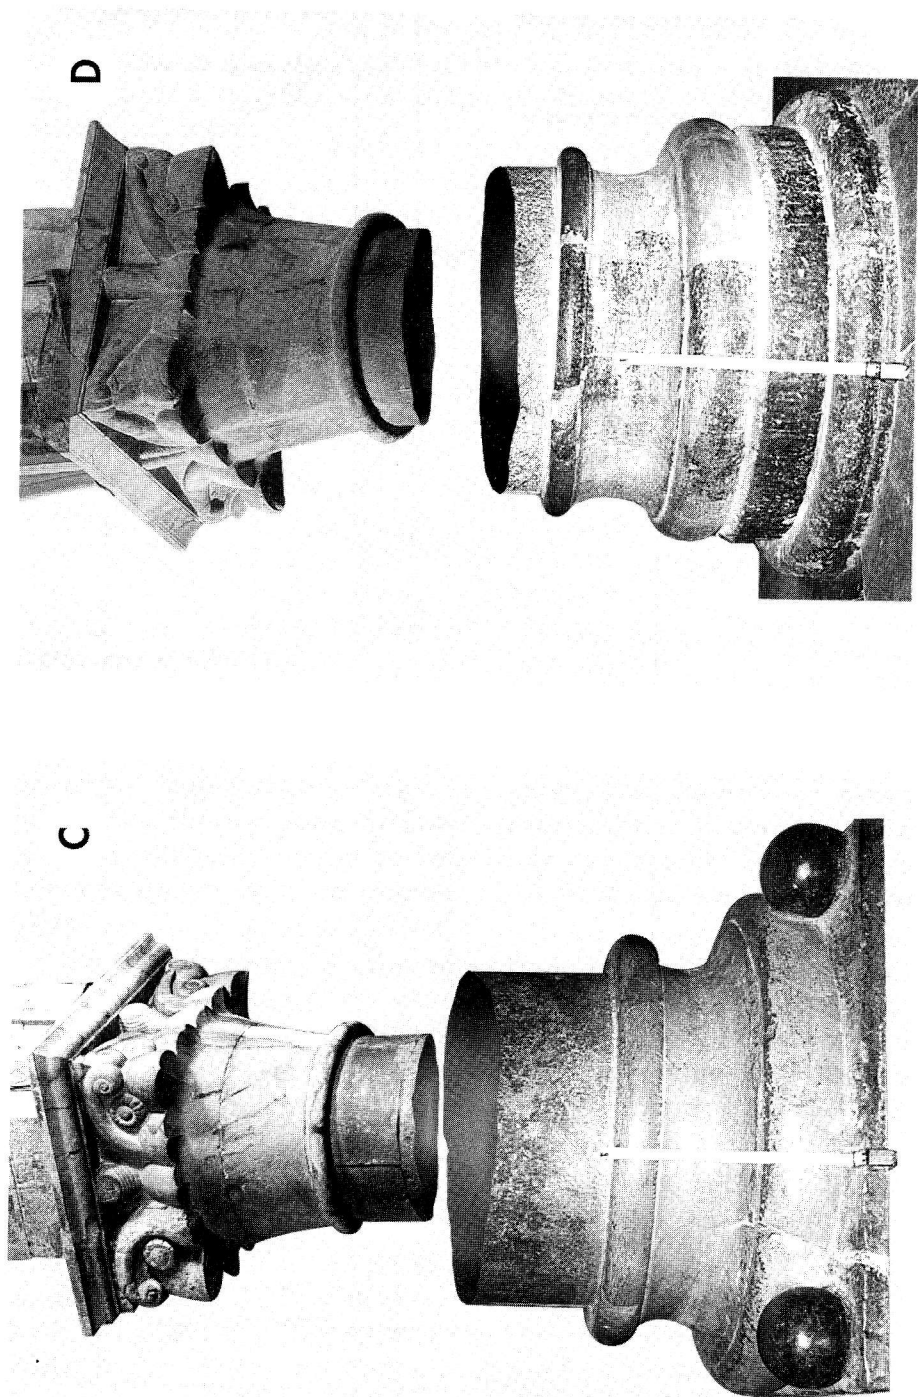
Fotografía de los capiteles y basas de las columnas C y D.
